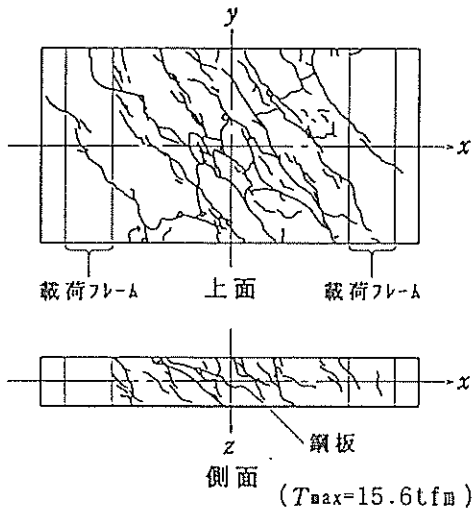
供試体 OS-22-200のひび割れ発生位置
